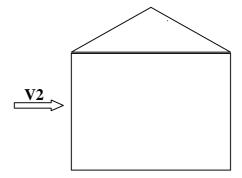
Vent sur la façade gauche et droite du hangar.
